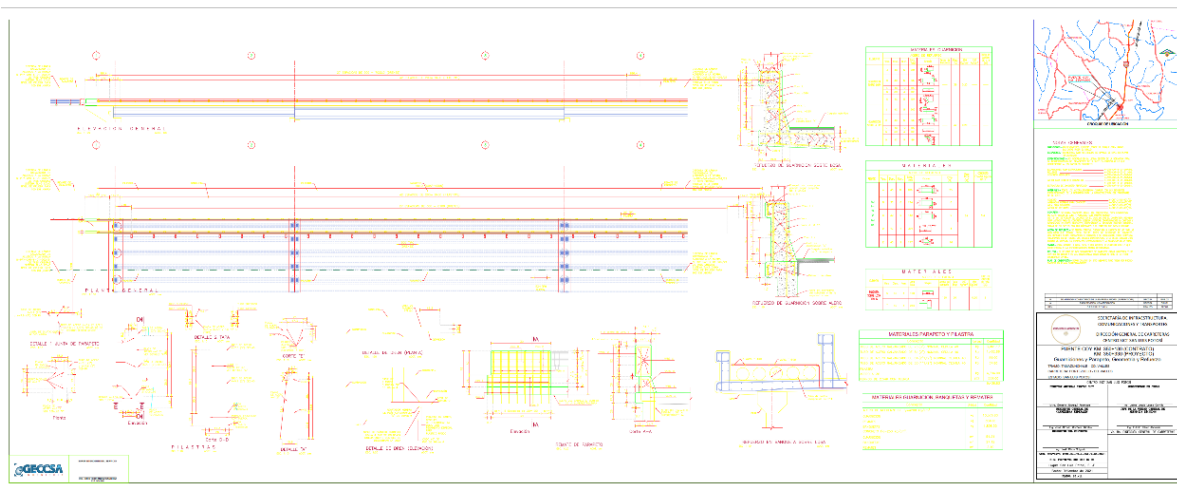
Plano de trabes no. 2. (Elaboración de equipo topográfico y estructural)
